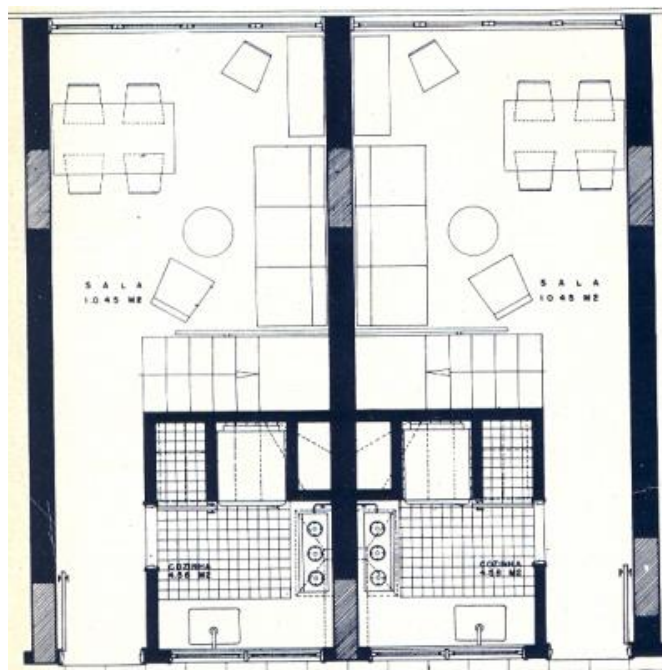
Tipologia duplex - planta baixa do pavimento de acesso – fonte: revista Arquitetura Contemporânea
